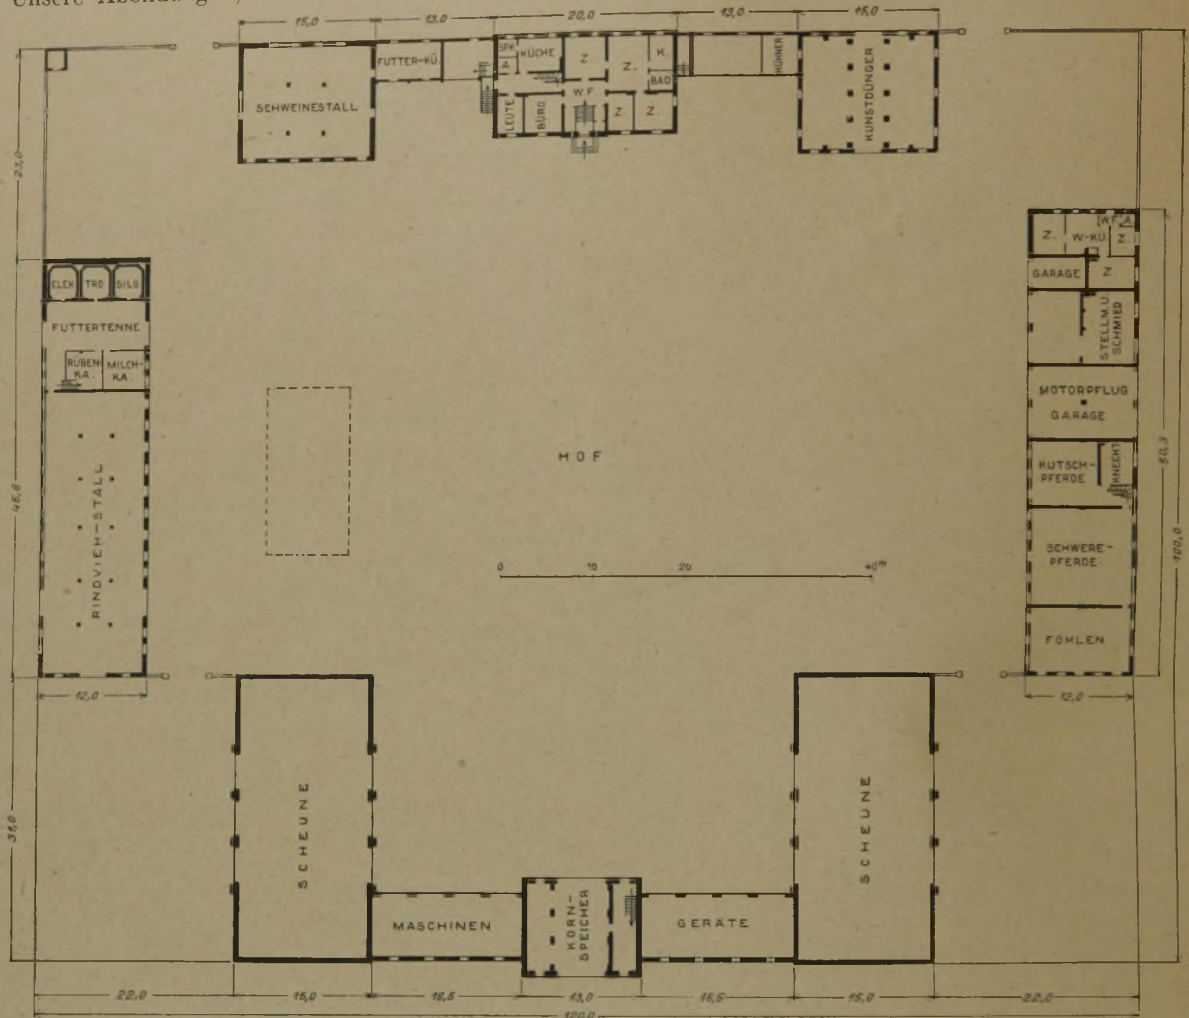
Lageplan mit Eintragung der Grundrisse der Einzelbauten. (1 : 800.)
